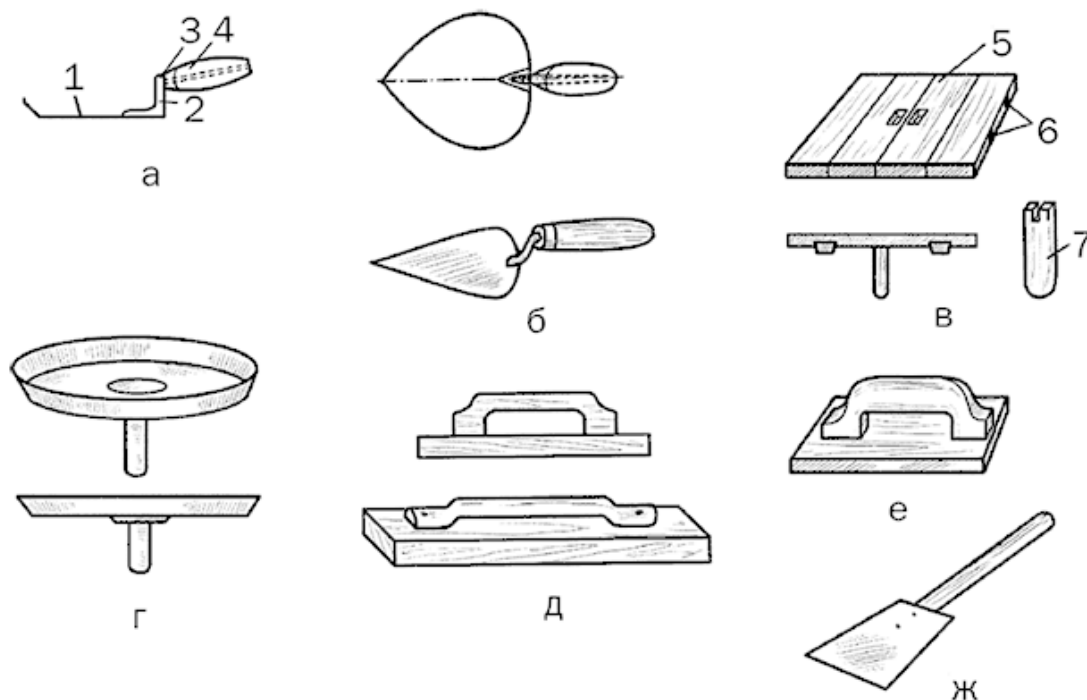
Инструменты для штукатурных работ: а – штукатурная кельма; б – отрезочка; в – деревянный сокол; г – полутерок; д – терка; е – правило; ж – скребок; 1 – полотно; 2 – колено; 3 – ручка; 4 – черенок; 5 – щит сокола; 6 – шпонки; 7 – ручка сокола
